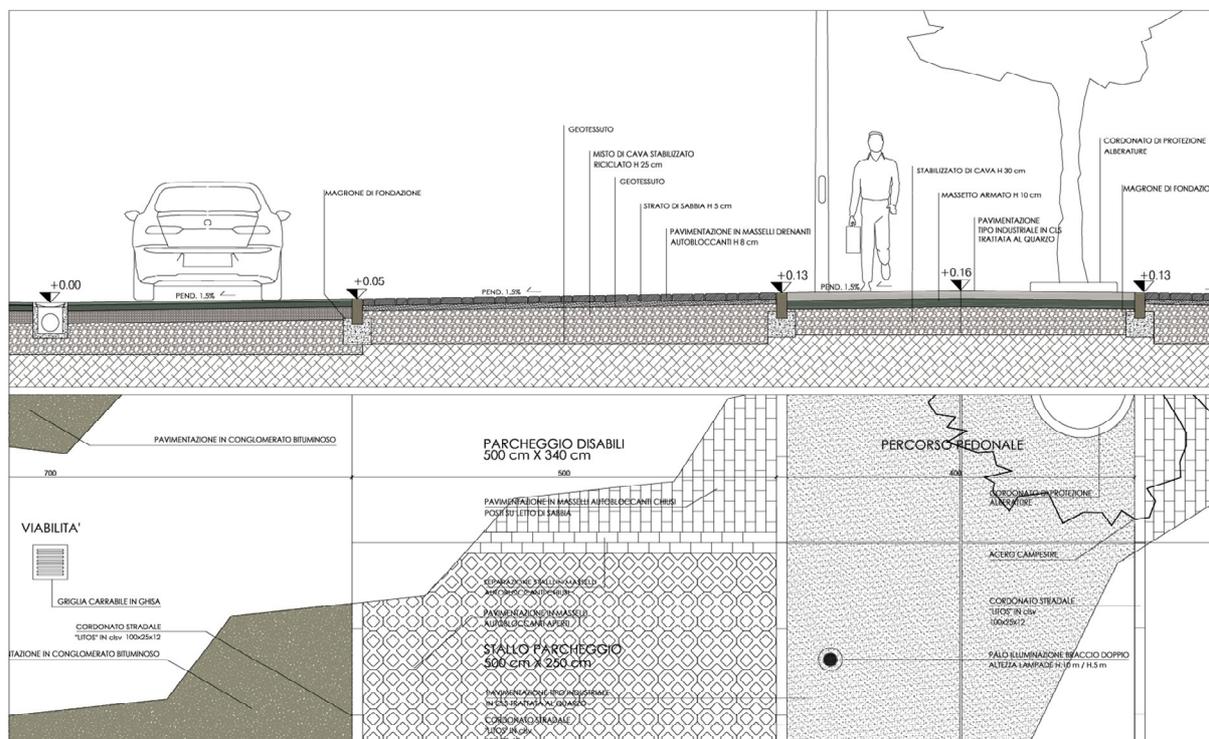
AEROPORTO DI FIRENZE – Pianta e Sezione tipo parcheggi
